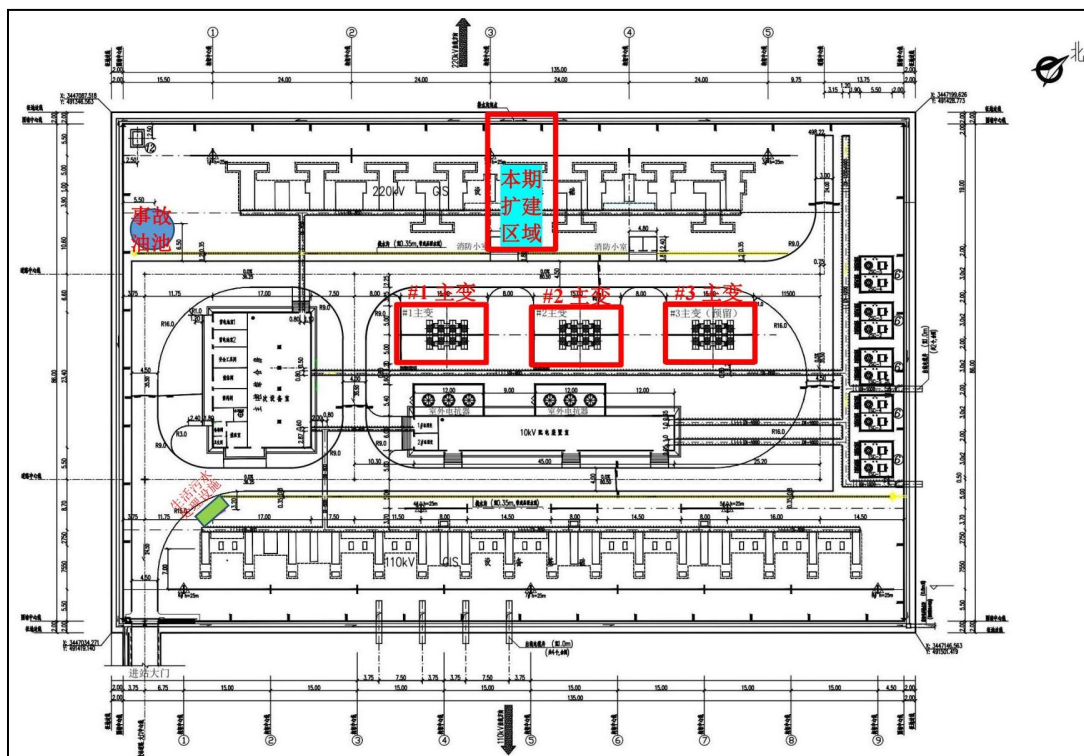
秋月 220kV 变电站总平面布置图及本期间隔扩建布置图
